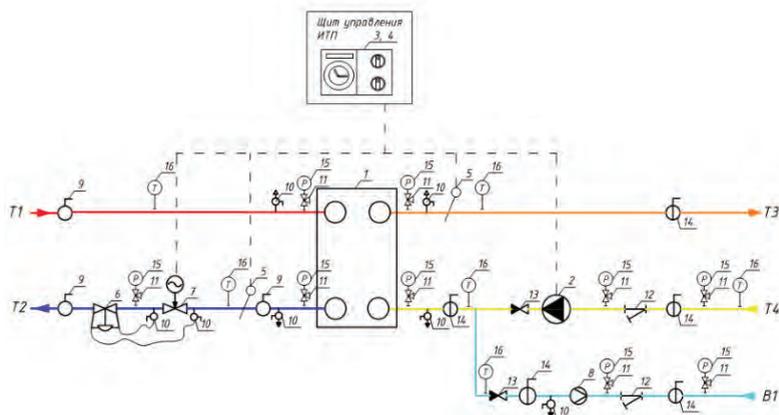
Схема теплоснабжения абонента после реконструкции
